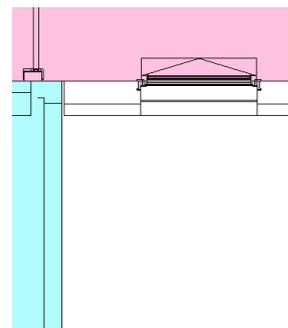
Encuentro entre fachadas alzado este del edificio
